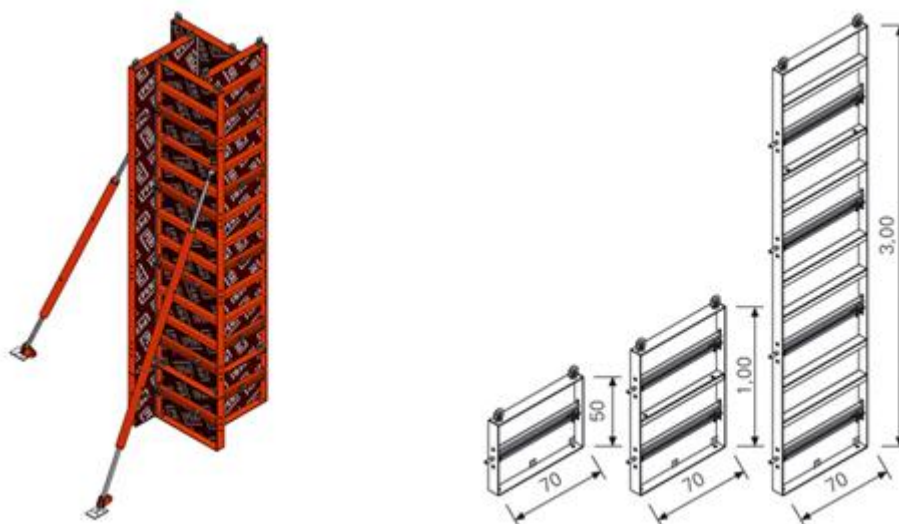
Esquema de uma cofragem de um pilar e painéis disponíveis (PERI s.d.).
